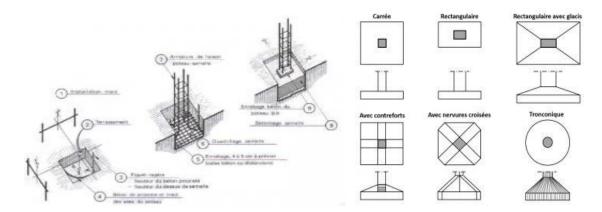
exemple de semelles isolées (la source : <a href="https://www.toutsurlebeton.fr/mise-en-oeuvre/la-semelle-isolee-fondation-superficielle-pour-poteau/">https://www.toutsurlebeton.fr/mise-en-oeuvre/la-semelle-isolee-fondation-superficielle-pour-poteau/</a>)
